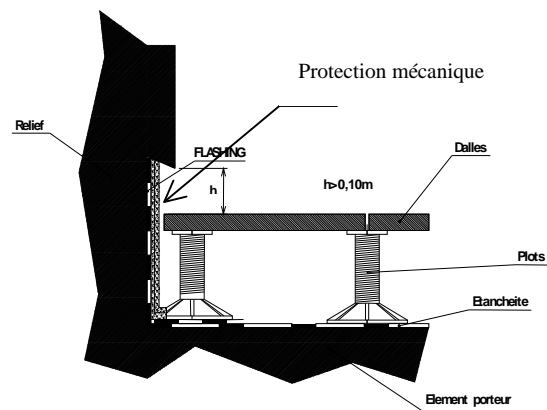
Niveau fini des dalles au-dessous du haut des relevés
